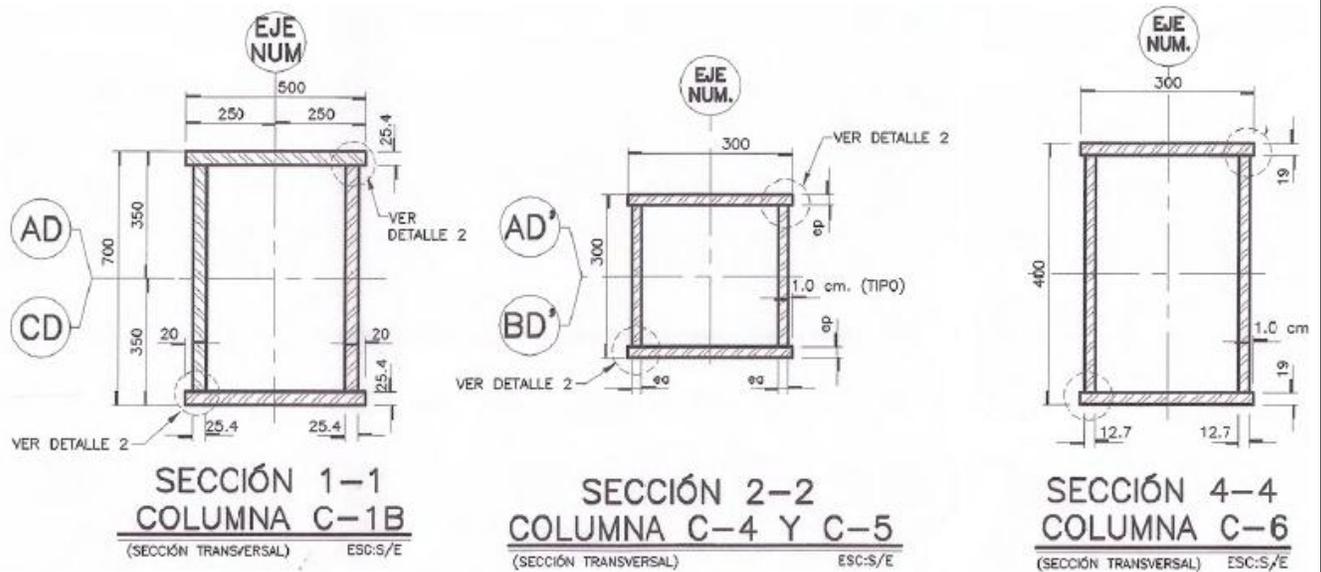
Sección de columnas tipo cajón principales C-1B y c-6, secundarias c-4 y c-5
